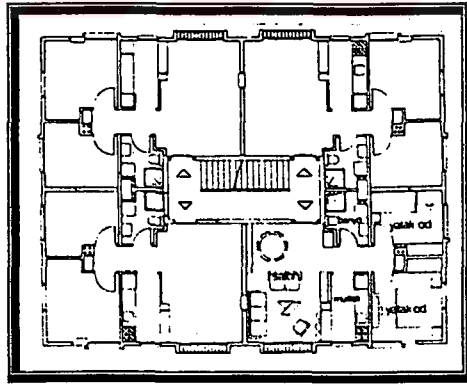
Düz kollu dikdörtgen basamaklı çift kollu merdiven (dörtlü daire planı)
